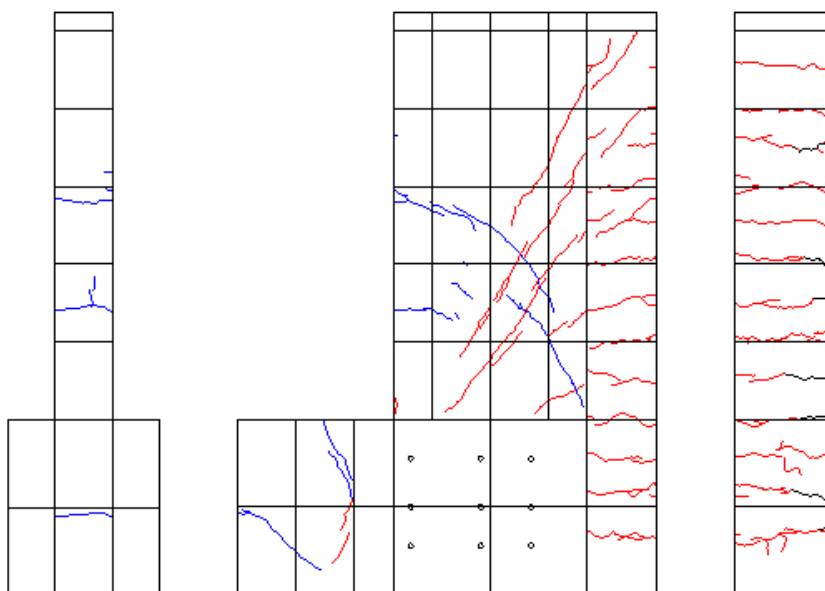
R=1/133②ひび割れ図
